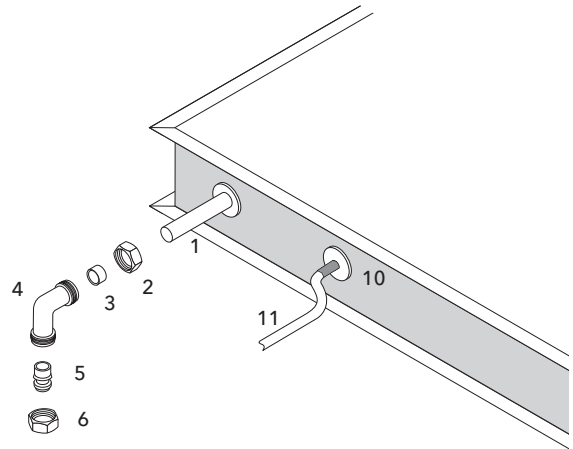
Solarkreis an Kollektor mit Klemmringverschraubungen anschließen, Kollektorfühler montieren.
